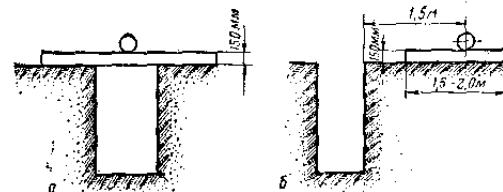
Схема укладки стальных труб на поверхность земли для сварки:
